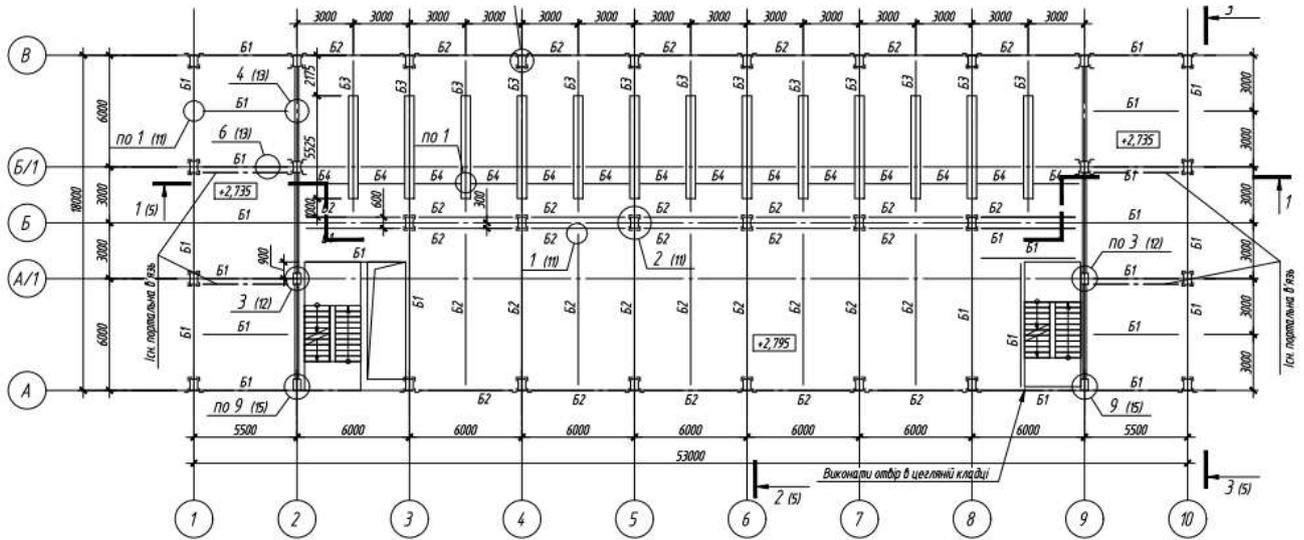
Схема розташування несучих сталевих балок нового вбудованого перекриття
